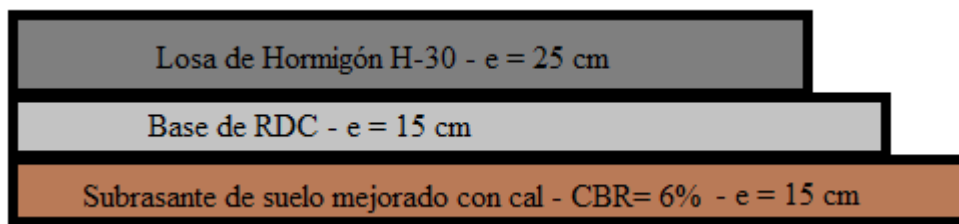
Croquis del paquete estructural. (Fuente: elaboración propia)
